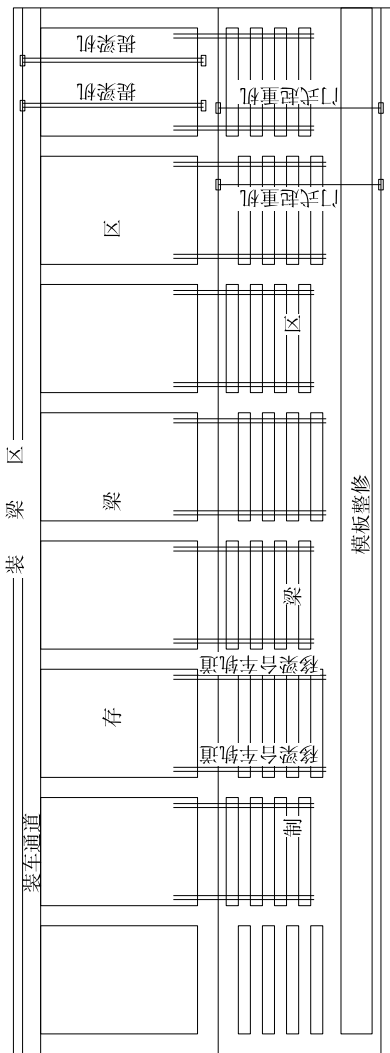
移梁台车移梁、提梁机搬梁、运梁车经运梁通道出梁平面布置图
